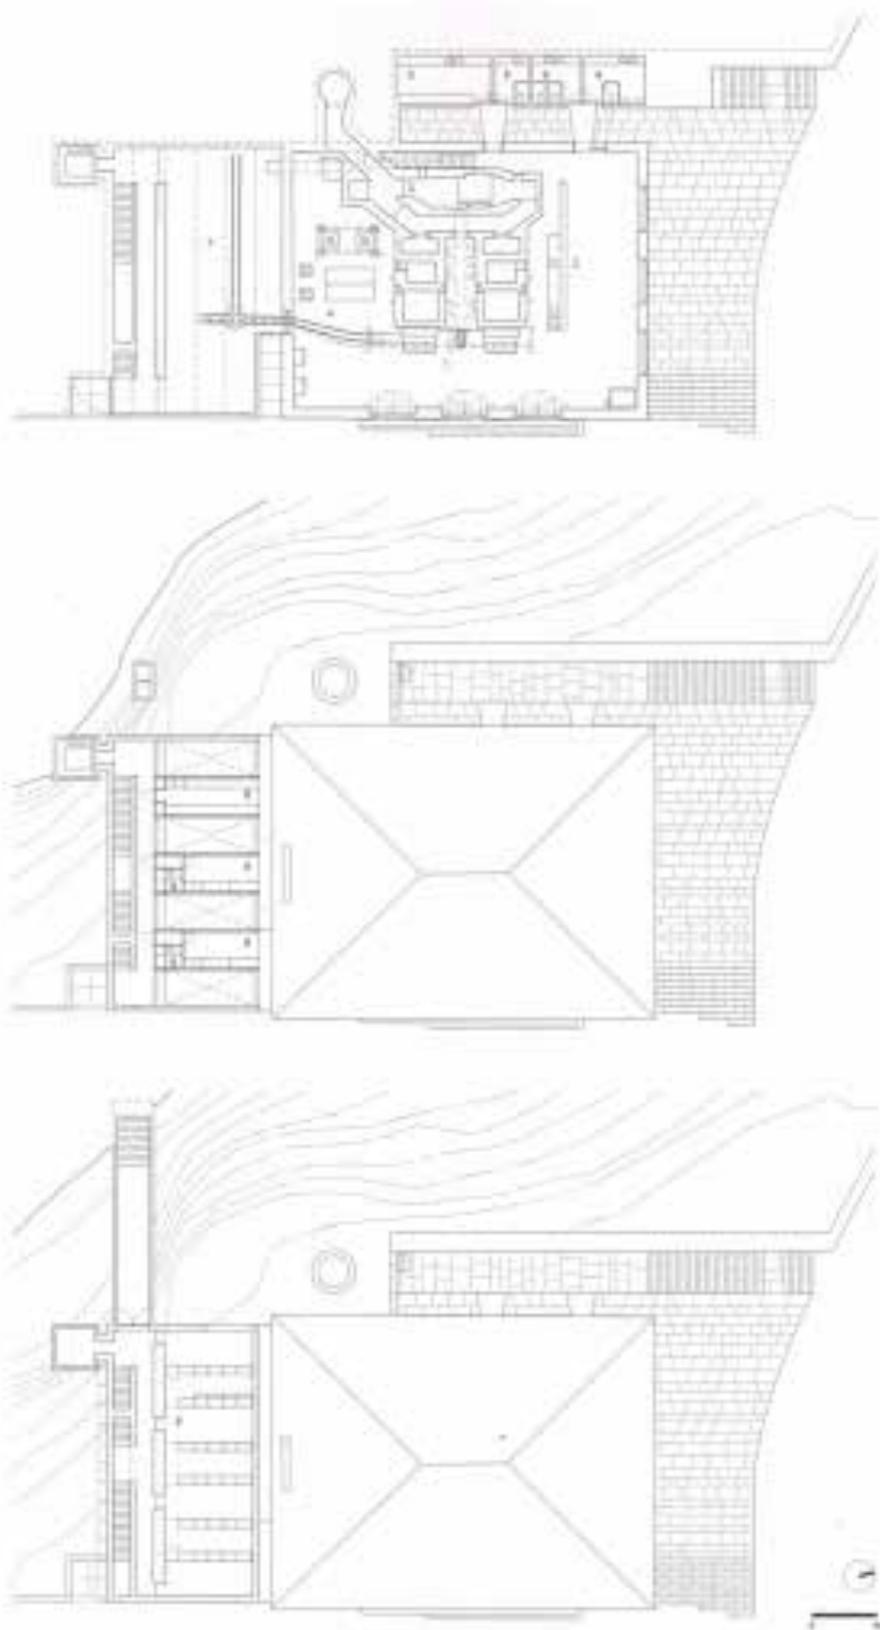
Planta Piso 0 | Planta Piso 2 | Planta Piso 3, 1.Sala das Caldeiras; 2.Bar; 3.Interior das Caldeiras;4.Livraria e Biblioteca; 5. Copa; 6. Instalações Sanitárias; 7.Auditório/Sala de Exposições; 8. Gabinetes; 9.Arquivo e Biblioteca. (Neves, 2016, p. 90)
